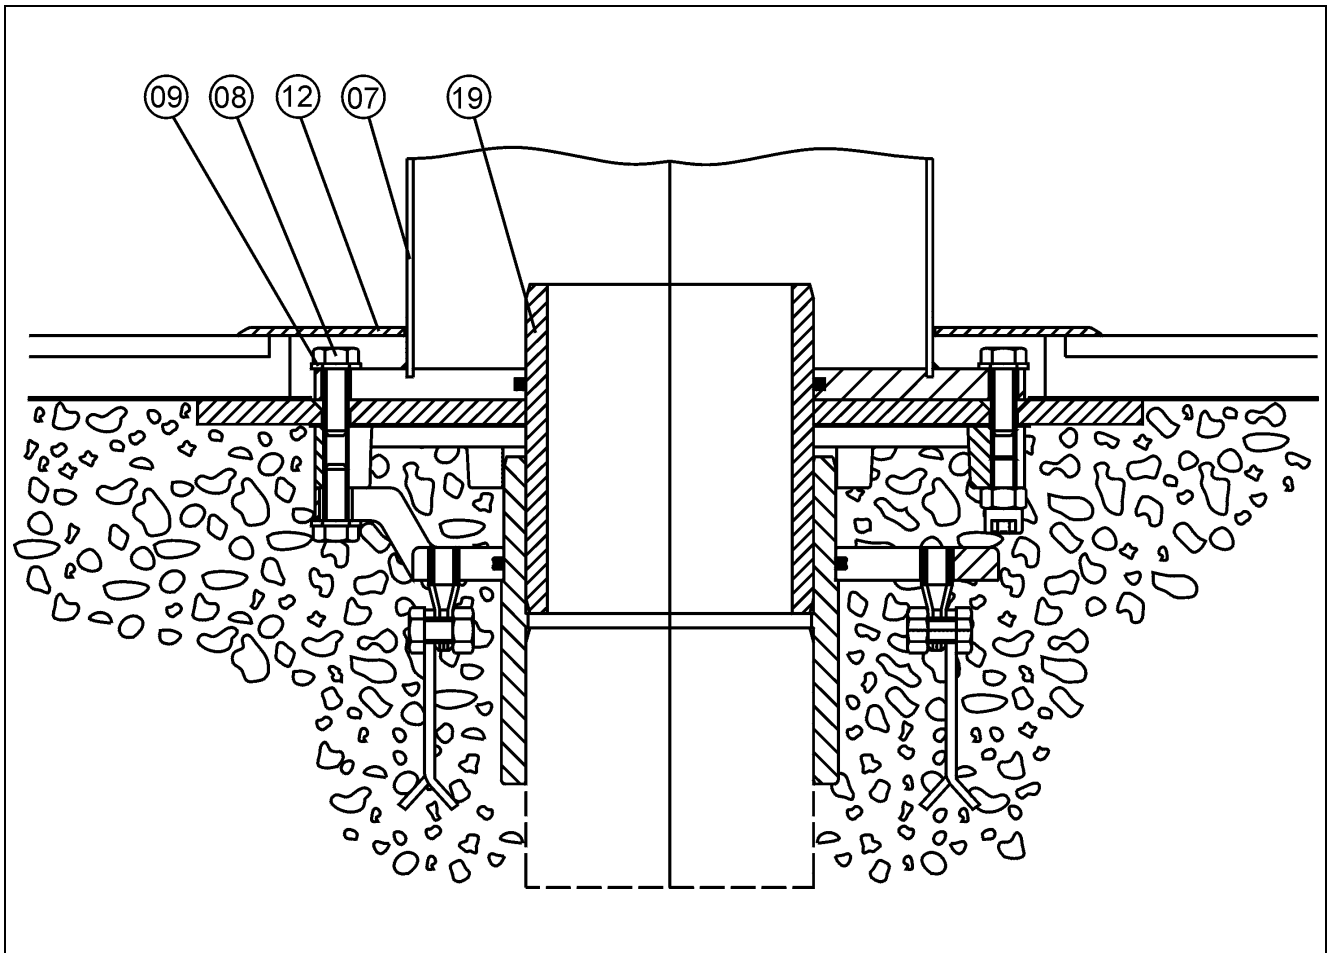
Betonbecken mit Streichfolie / Wasserzuführung senkrecht
